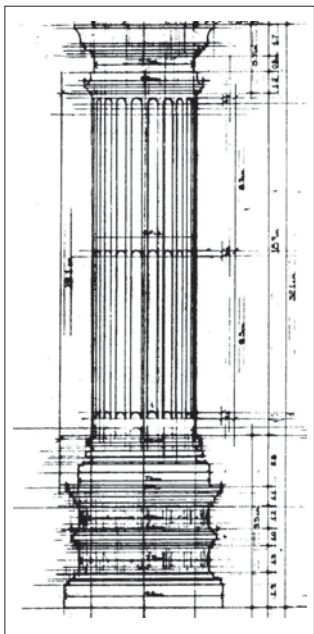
Alzado de una columna de la capilla abierta de Teposcolula (López)
